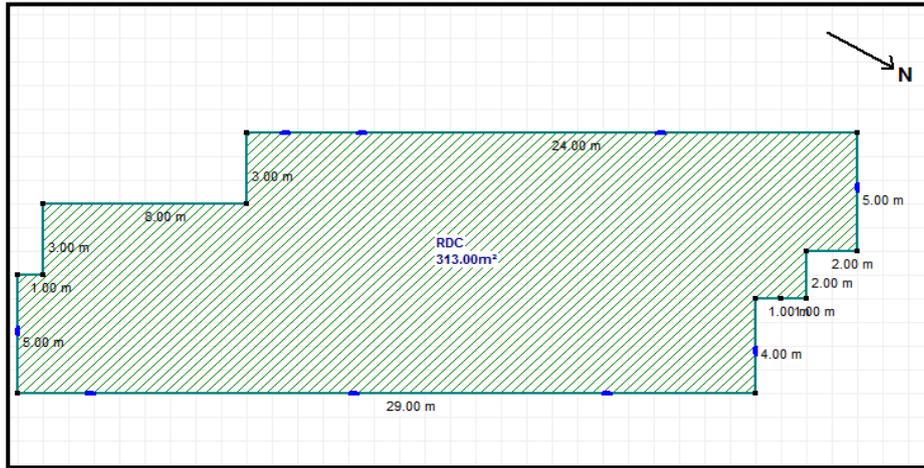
plan de RDC alcyone(Source : Auteur)
